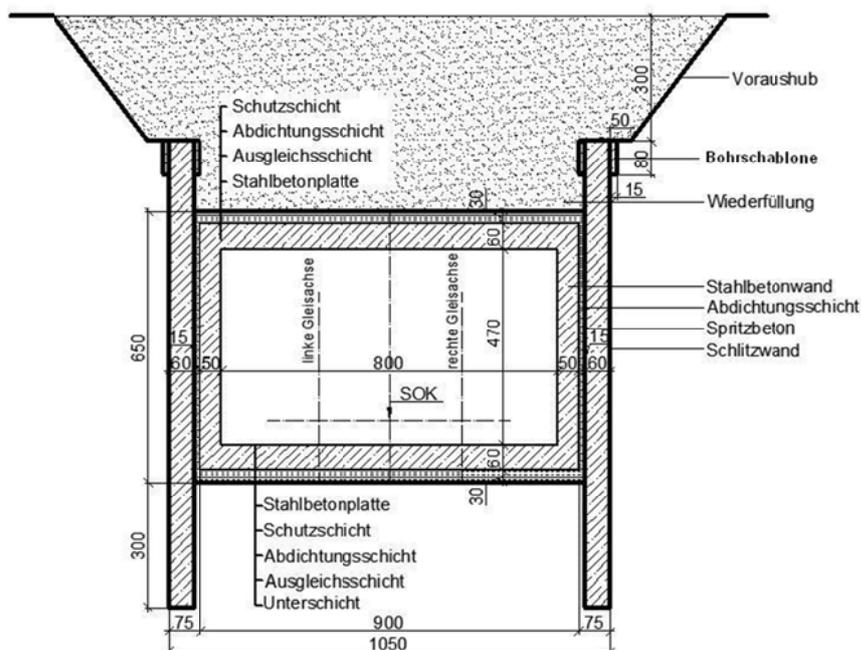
Tunnelquerschnitt in einer Blockfuge
